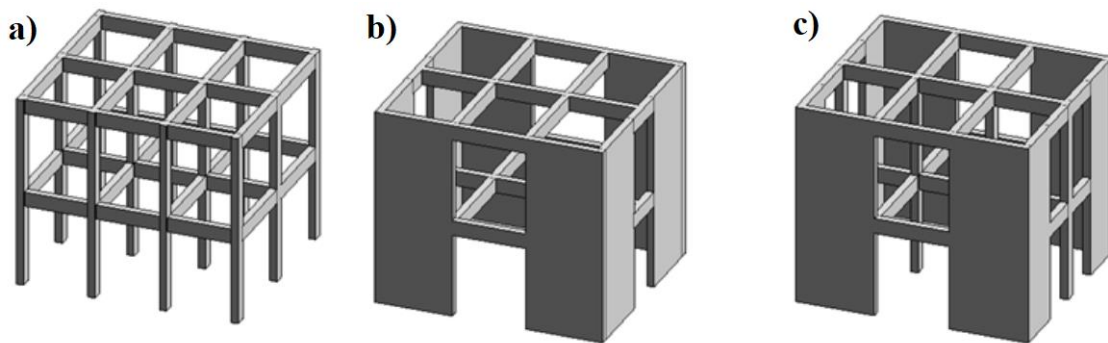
a) Sistema estructural de pórticos, b) Sistema estructural de muros estructurales, c) Sistema estructural dual. (Ceballos, 2019)
